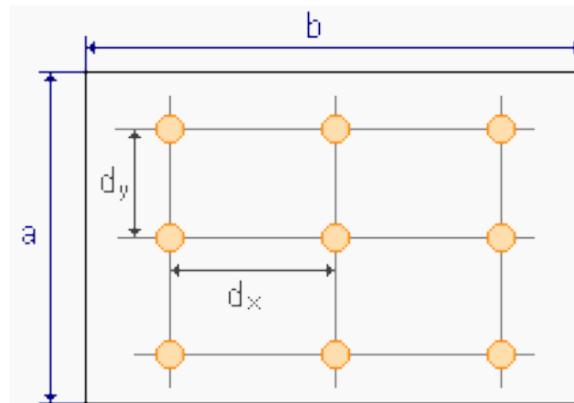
Emplazamiento de luminarias en local de planta rectangular.
